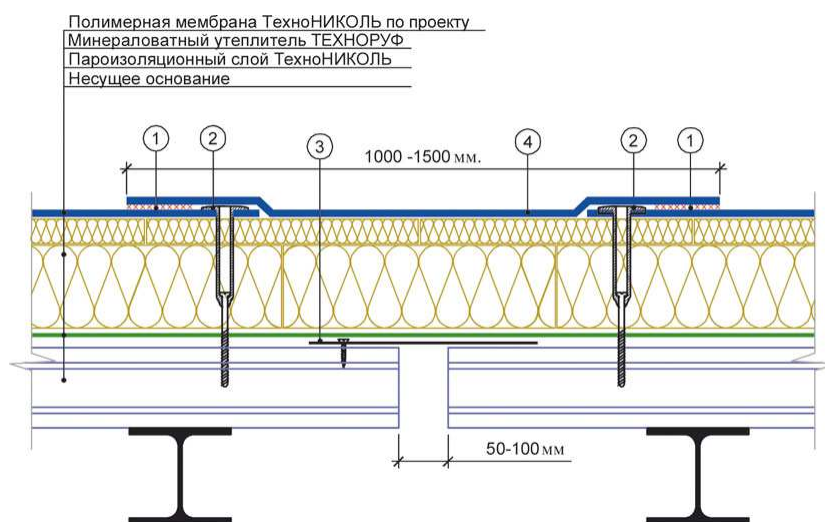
Спрощена конструкція деформаційного шва (покрівля ТН-класик) : 1 - зварювальний шов 30 мм; 2-телескопічний кріпильний елемент; 3 - смуга з оцинкованої сталі завтовшки 1 мм(закріплюється з одного боку); 4 - неармована мембрана
